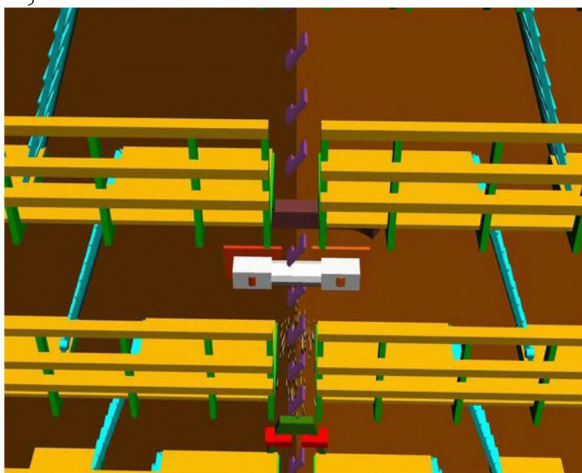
Установка гребенок и сварка блоков между собой
